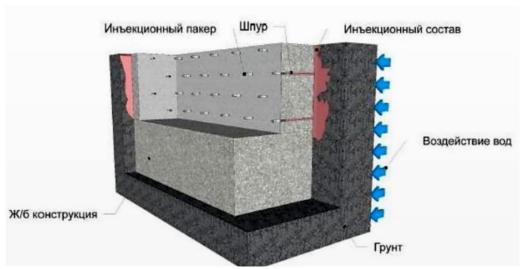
Вуальная гидроизоляция методом инъектирования
